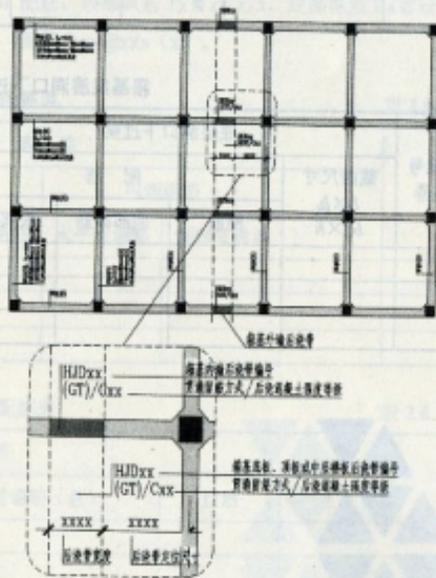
箱基板和墙体后浇带平面图注写示意
